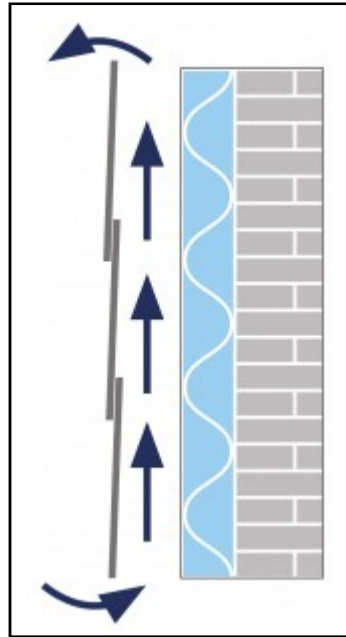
Le fonctionnement et les avantages du système de façade ventilée
